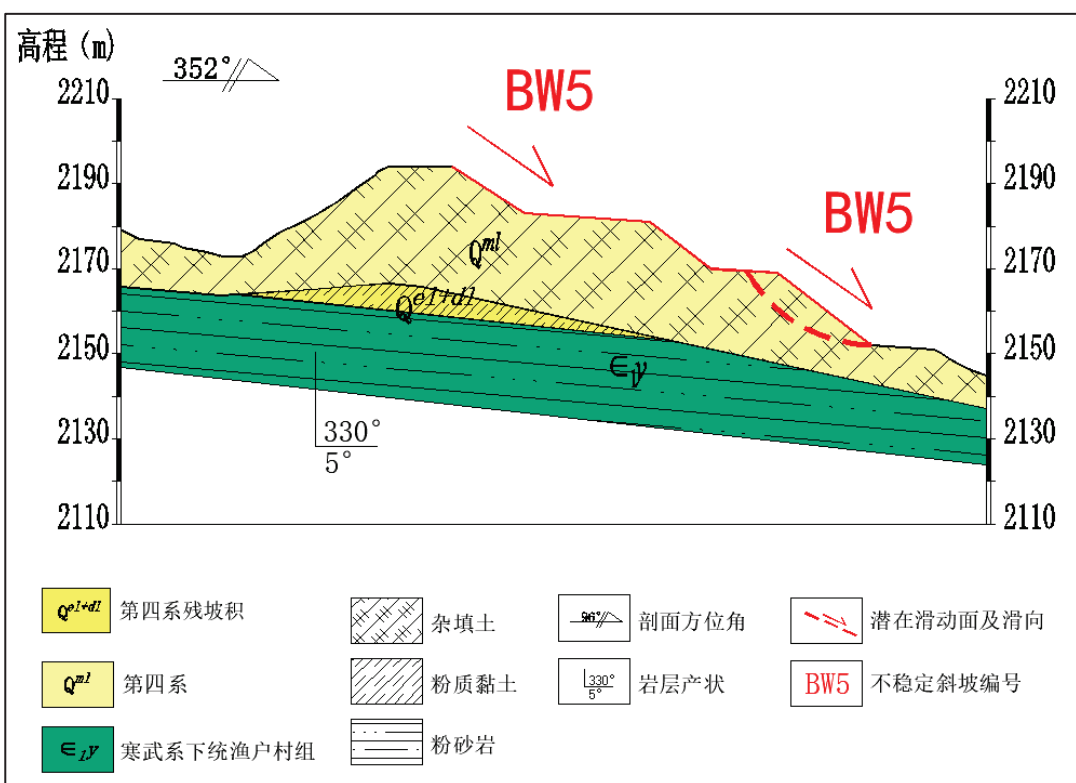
BW₅ 不稳定边坡地质剖面图
